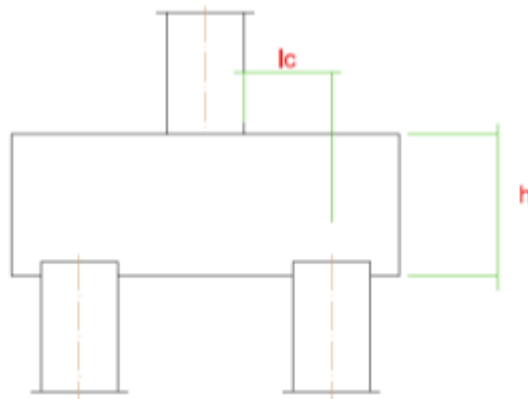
Distancia da face do pilar ao eixo da estaca.
